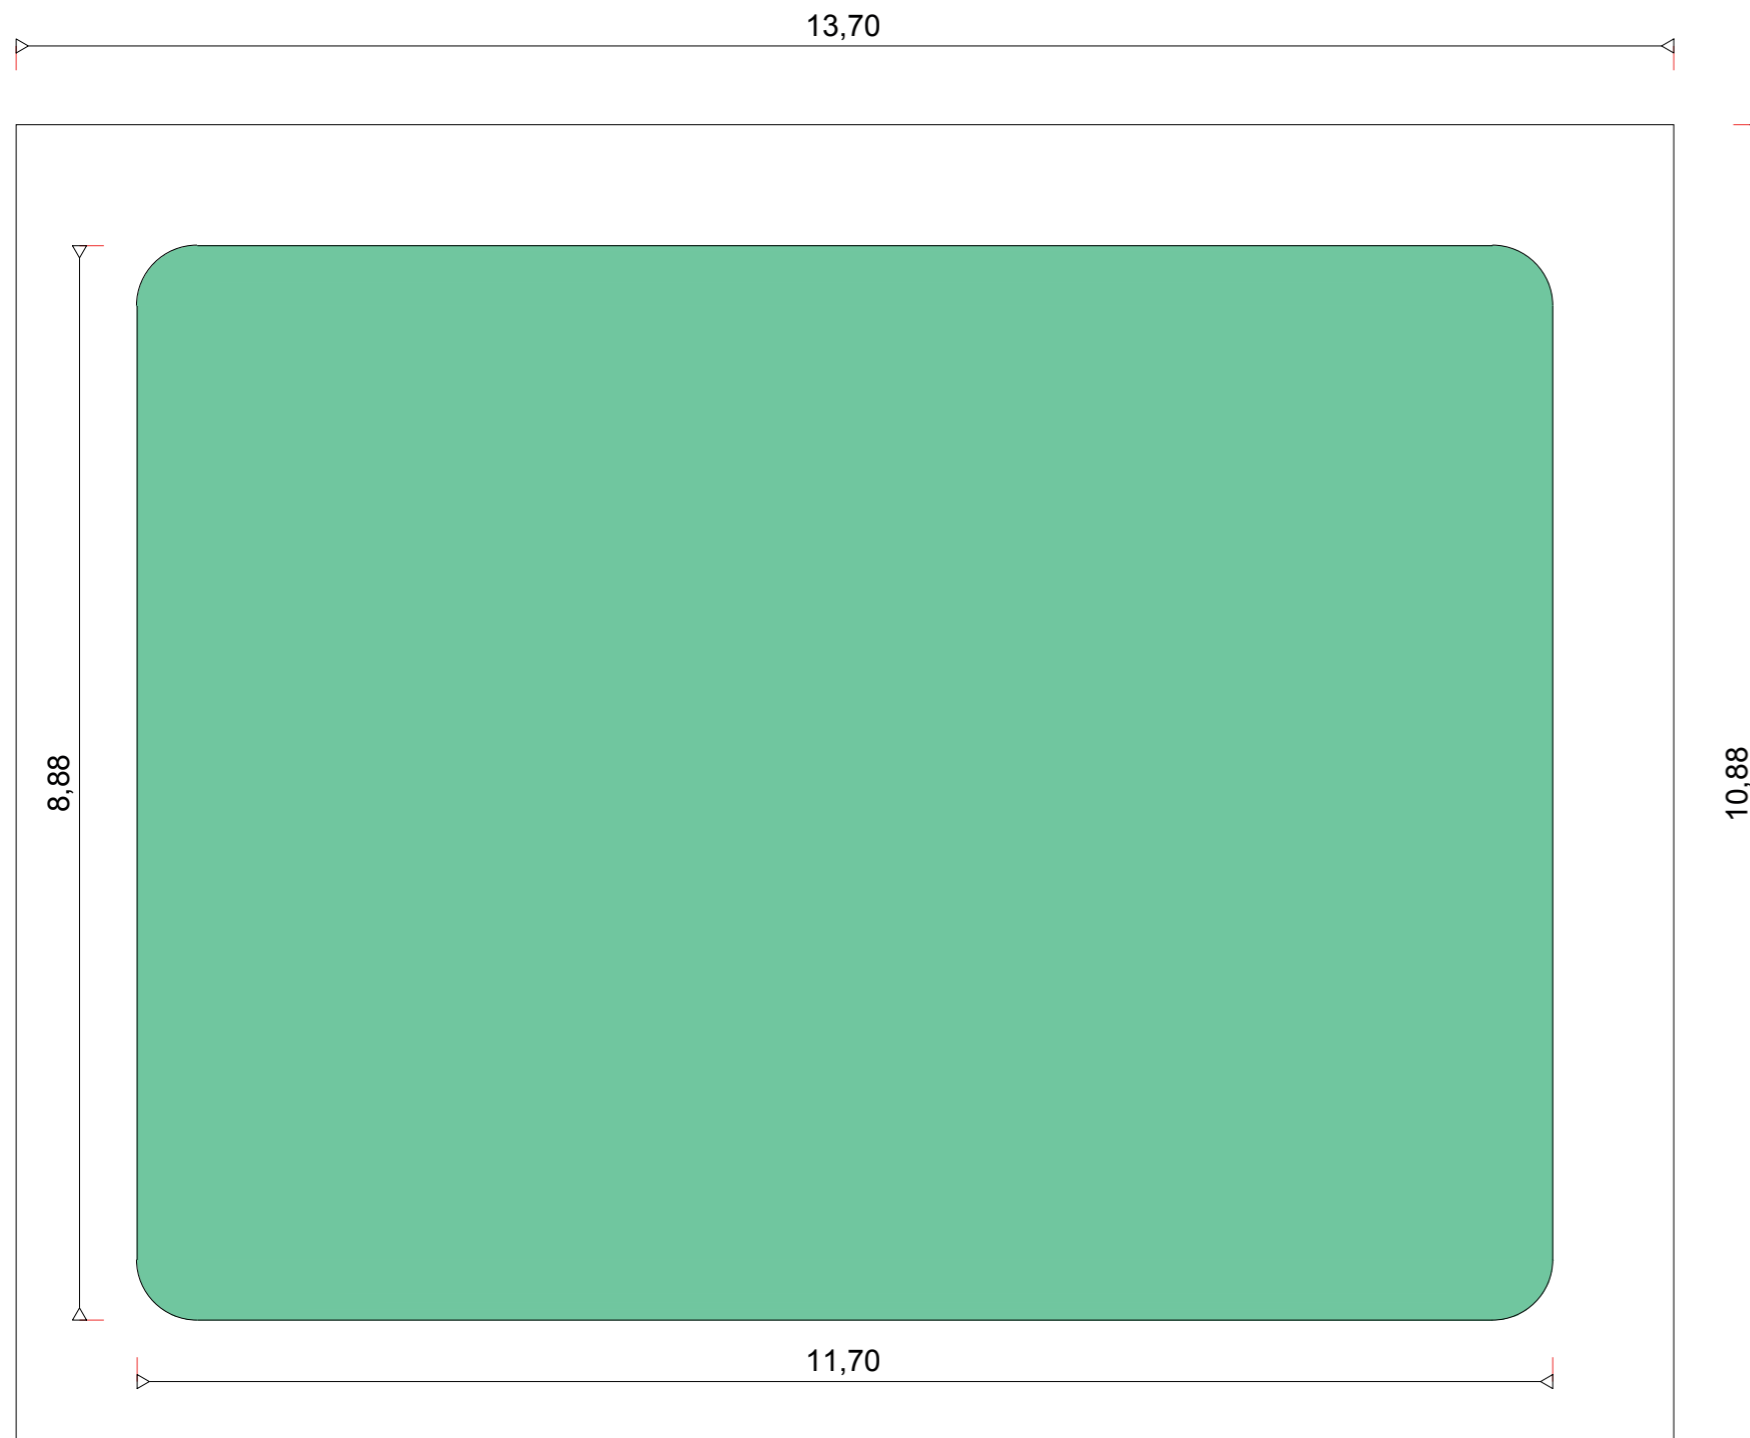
DETAILS - ÉLÉVATIONS DE LA CAMÉRA - échelle 1/40e
